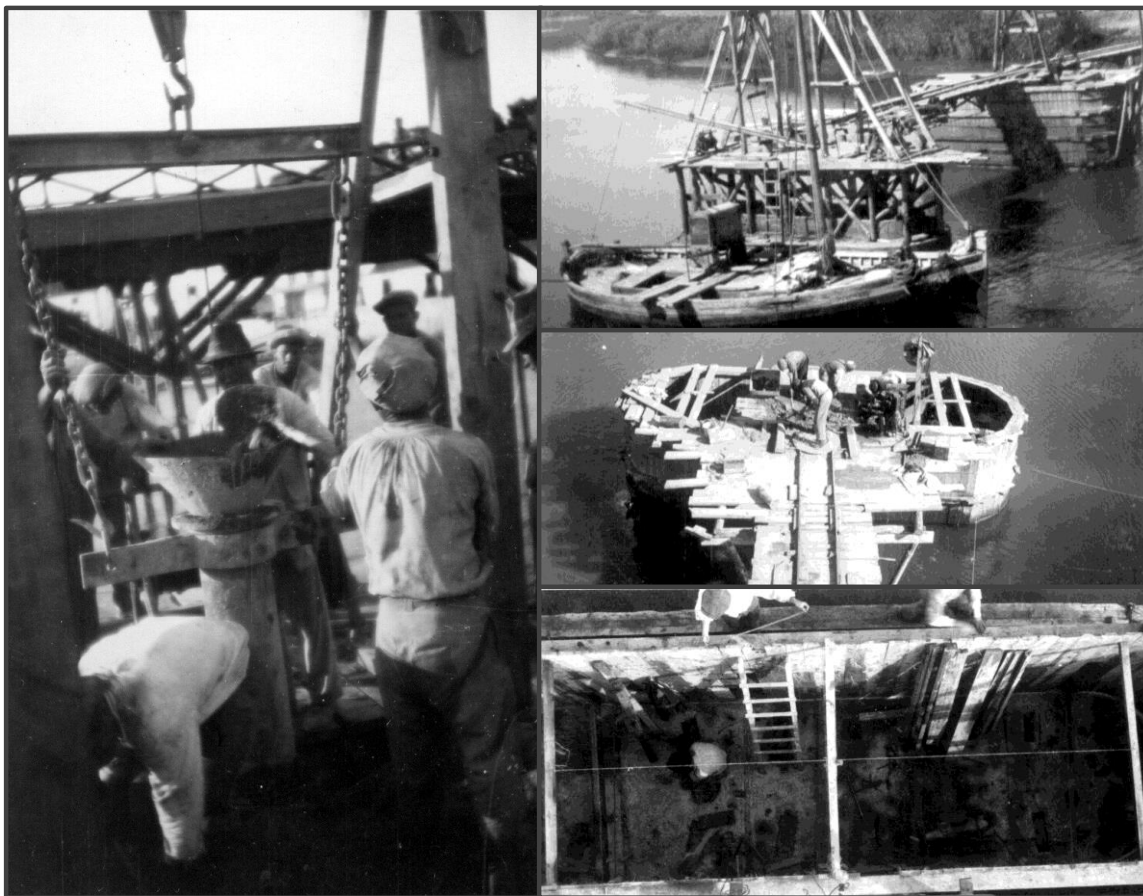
Imagens da coluna de betonagem, da linha férrea de acesso e fornecimento de betão (através de vagões), e do enchimento do interior dos cofres
